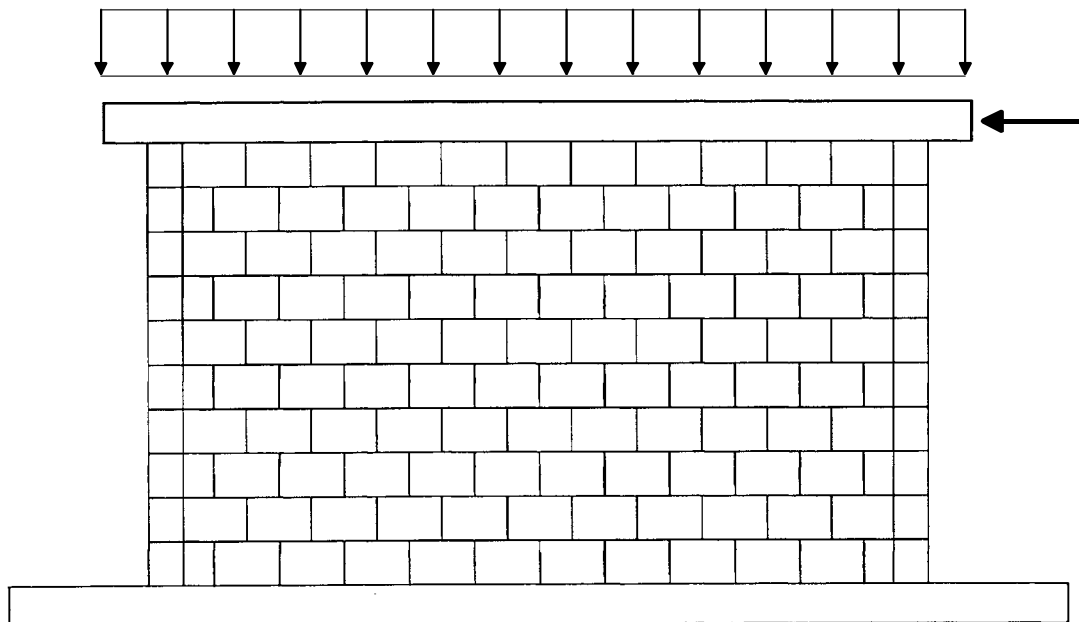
Mauerwerkswand mit zweiachsiger Beanspruchung [L5].
